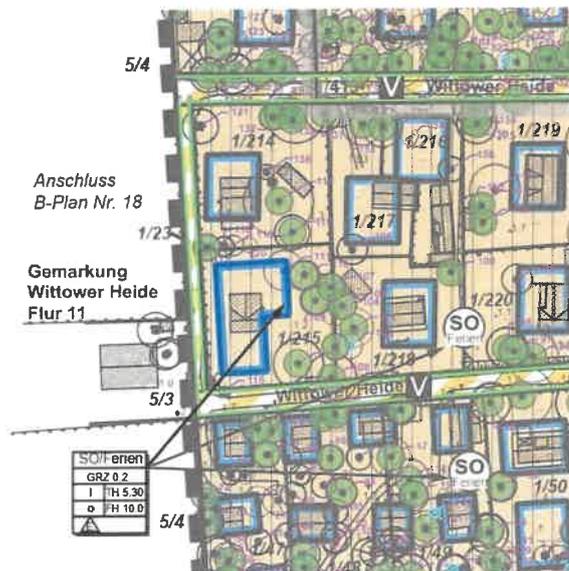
Ausschnitt Planzeichnung, Stand 4. Änderung
